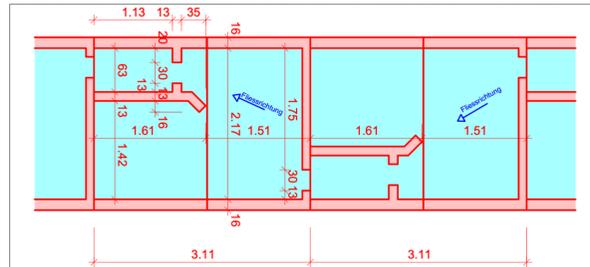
Grundriss Multi-Struktur-Schlitzpass
